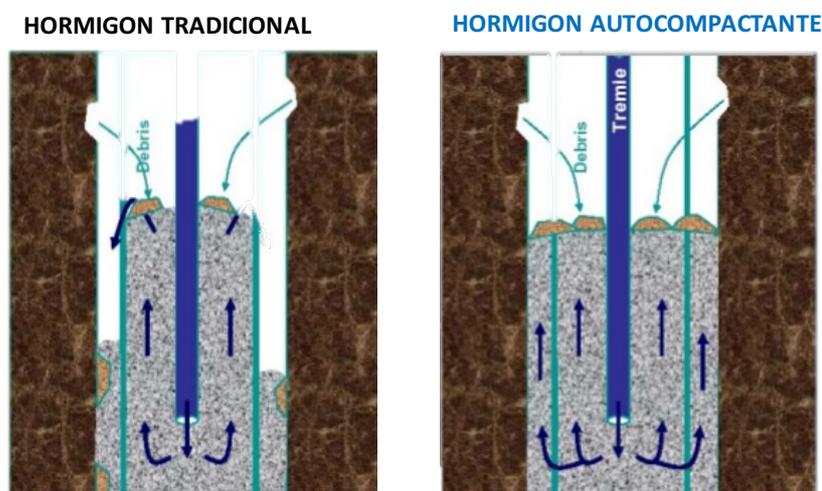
Hormigón autocompactante ( <https://www.slideshare.net/PrasadRaju26/scc-by-mlv-prasad>)
